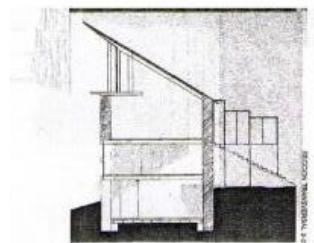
Sección proyecto básico [aSZ arquitectes]
